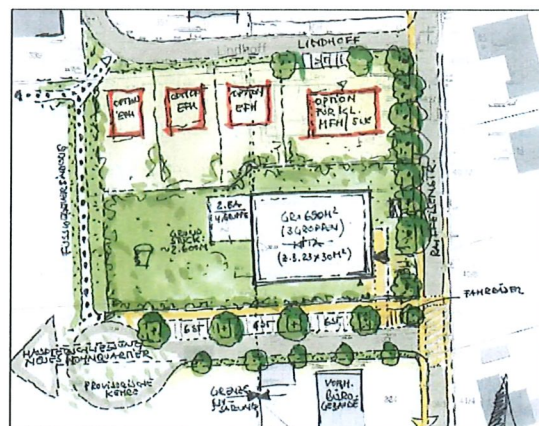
Städtebauliches Konzept (Quelle: Architektur + Stadtplanung, Hamburg)
